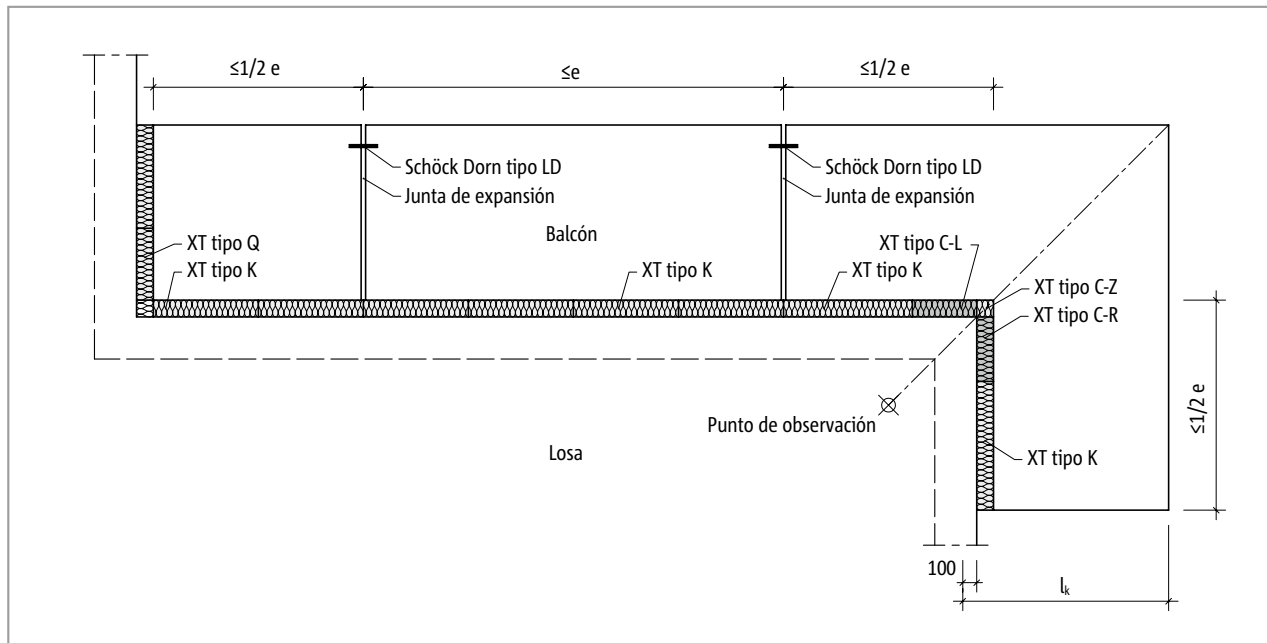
Schöck Isokorb® XT tipo C: Disposición de las juntas de expansión
